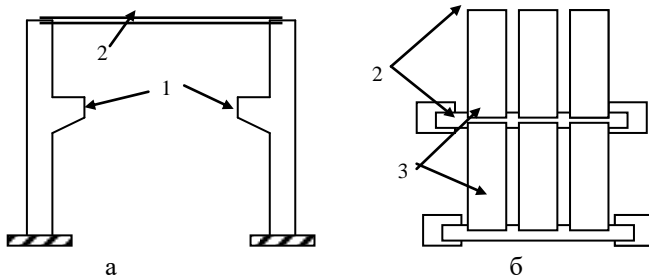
Железобетонный каркас верхнего строения насосной станции:
